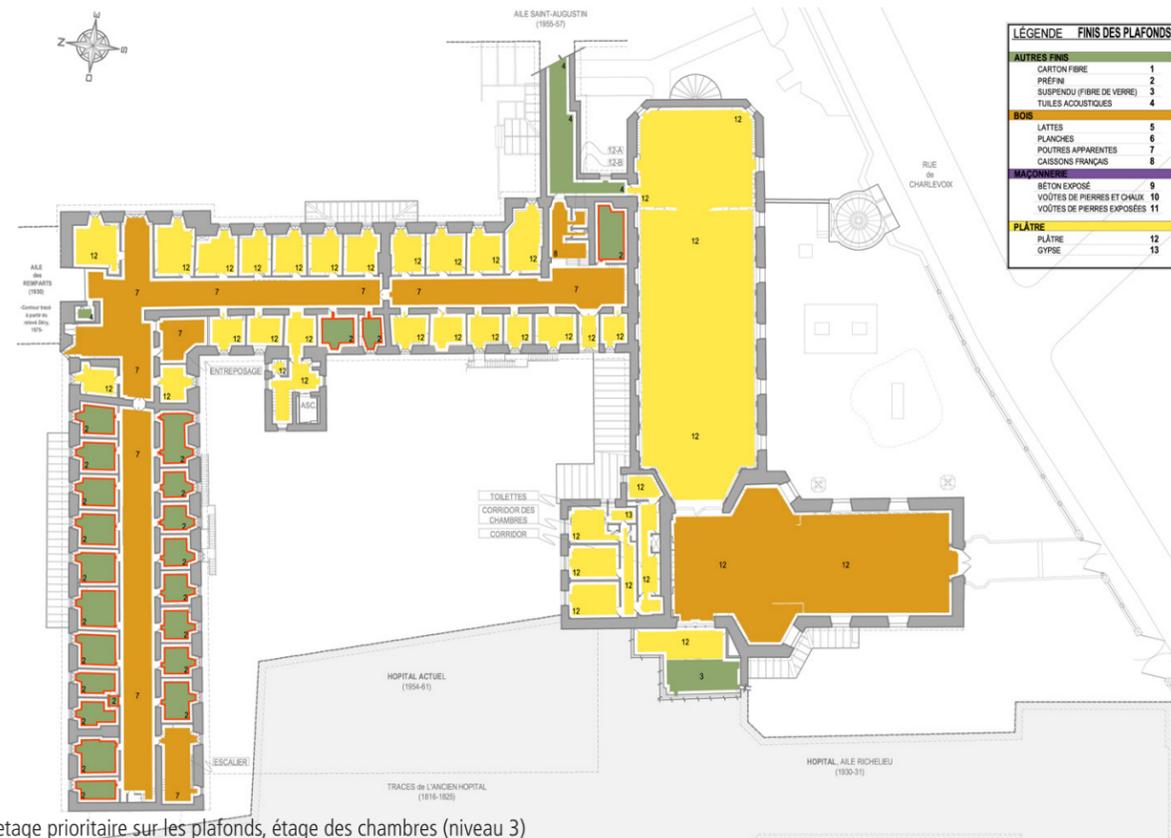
Plan de curetage prioritaire sur les plafonds, étage des chambres (niveau 3)
